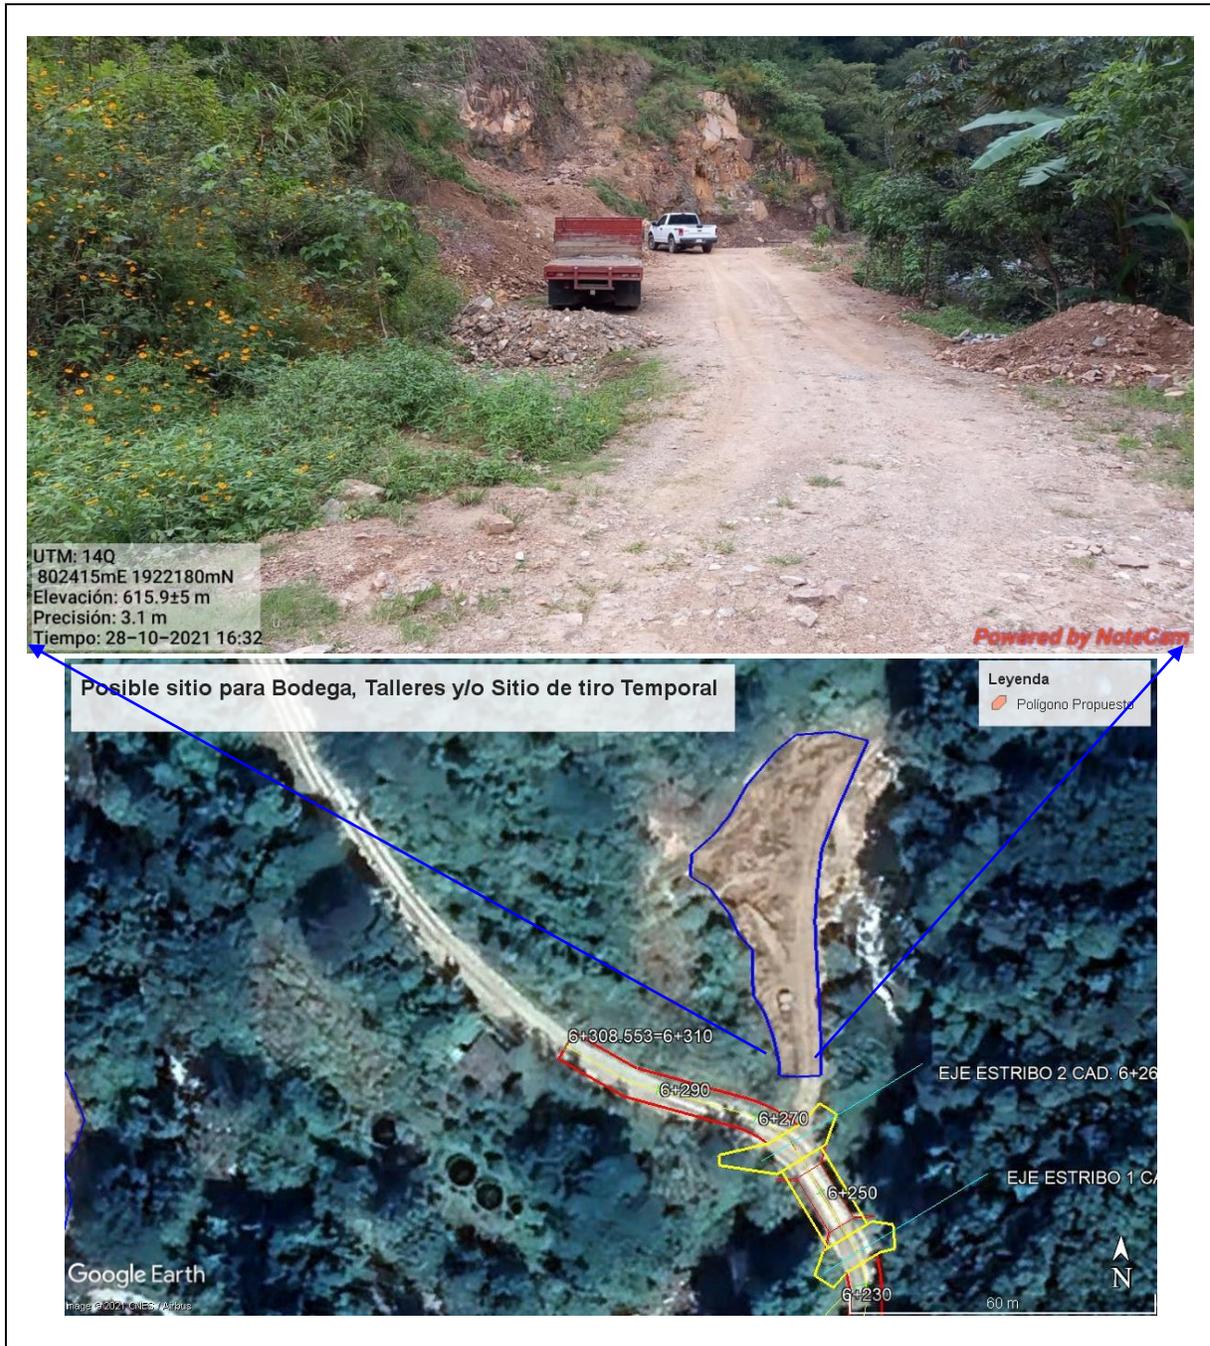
Sitio para Bodega, Talleres y/o Sitio de tiro Temporal, colindante con el proyecto.
